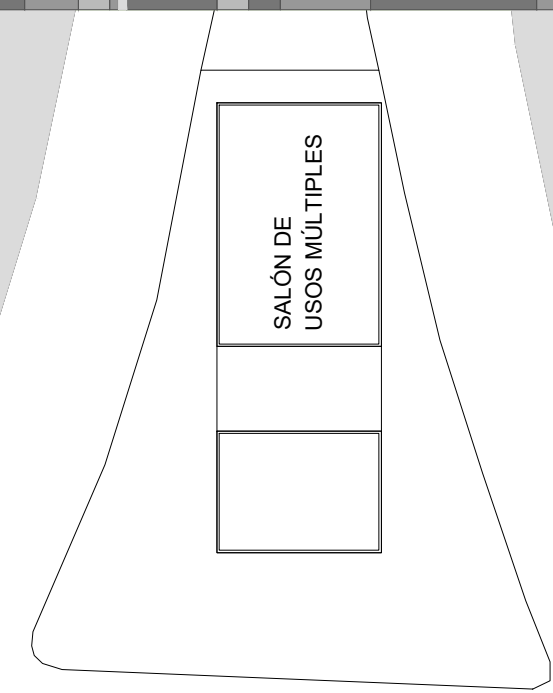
Alzado esquemático de la propuesta. Fuente: Elaboración propia.
